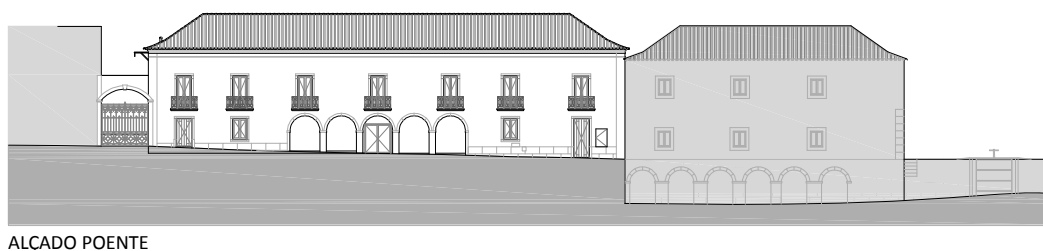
O Palacete dos Condes de Sampayo: fachada norte e ligação a Moinho de Maré.
